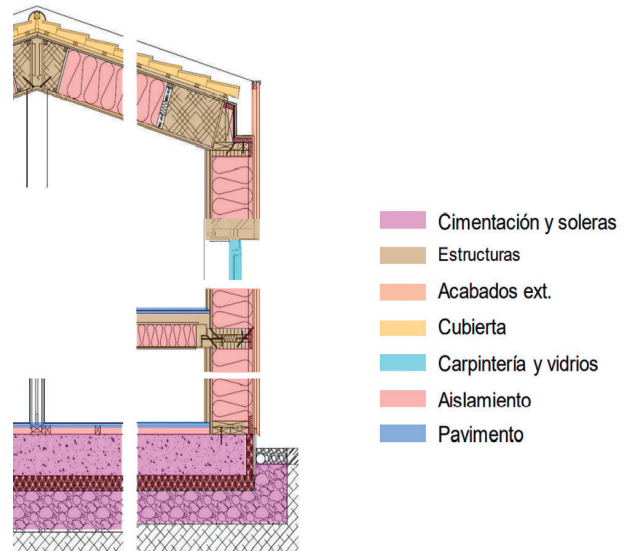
Proyecto Construcción de Madera Sección de Fachada
